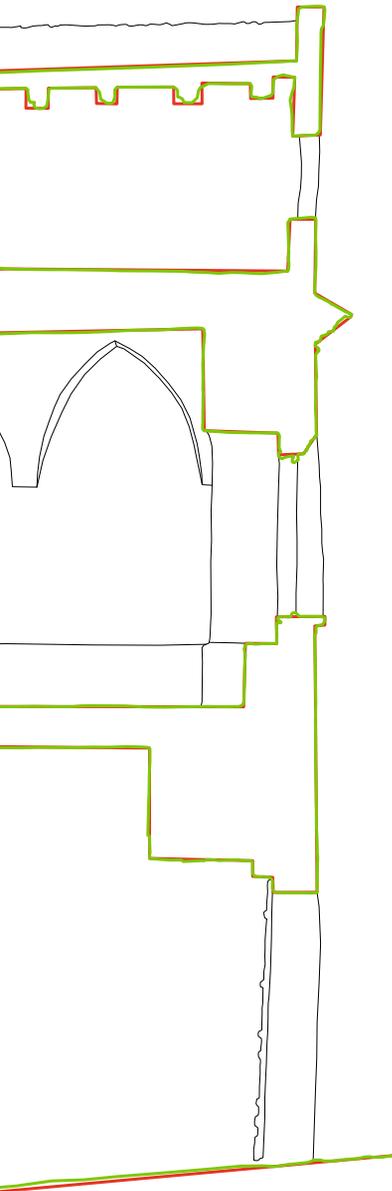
Überlagerung der Grundrisse 2.OG M 1:100
